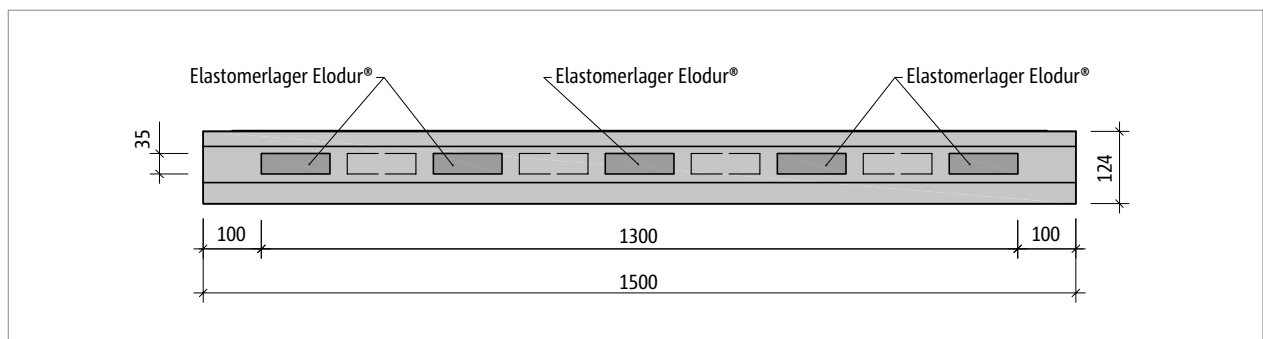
Schöck Tronsole® Typ F: Grundriss
